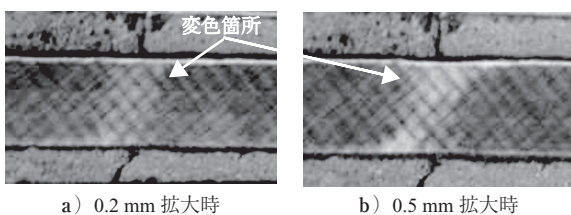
ケース B の変色状況（ひび割れ有）
